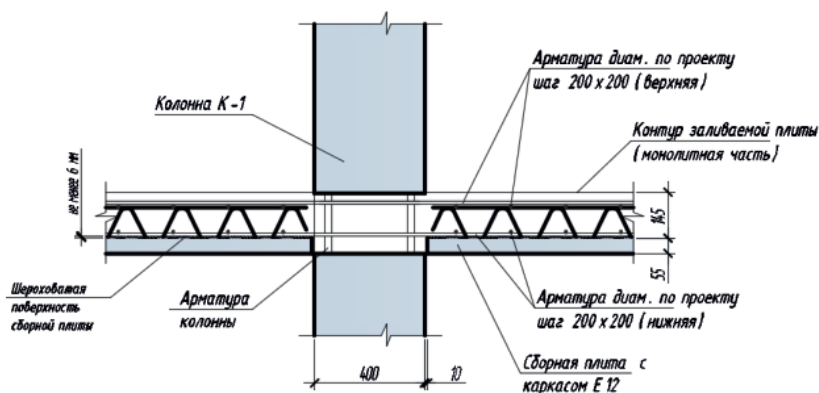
Узел безбалочного сборно-монолитного перекрытия с применением несъемной железобетонной опалубки
